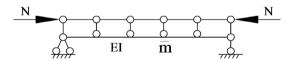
Diagram of simply supported beam truss system 图 2. 简支梁桁架体系简图
